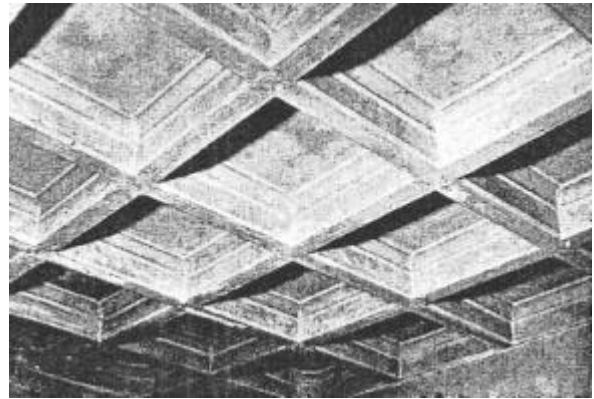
William B. Wilkinson, Landhaus, Newcastle-upon-Tyne, um 1865/1866, Detail der Decke innen (aus: Newby 2001, 60)
